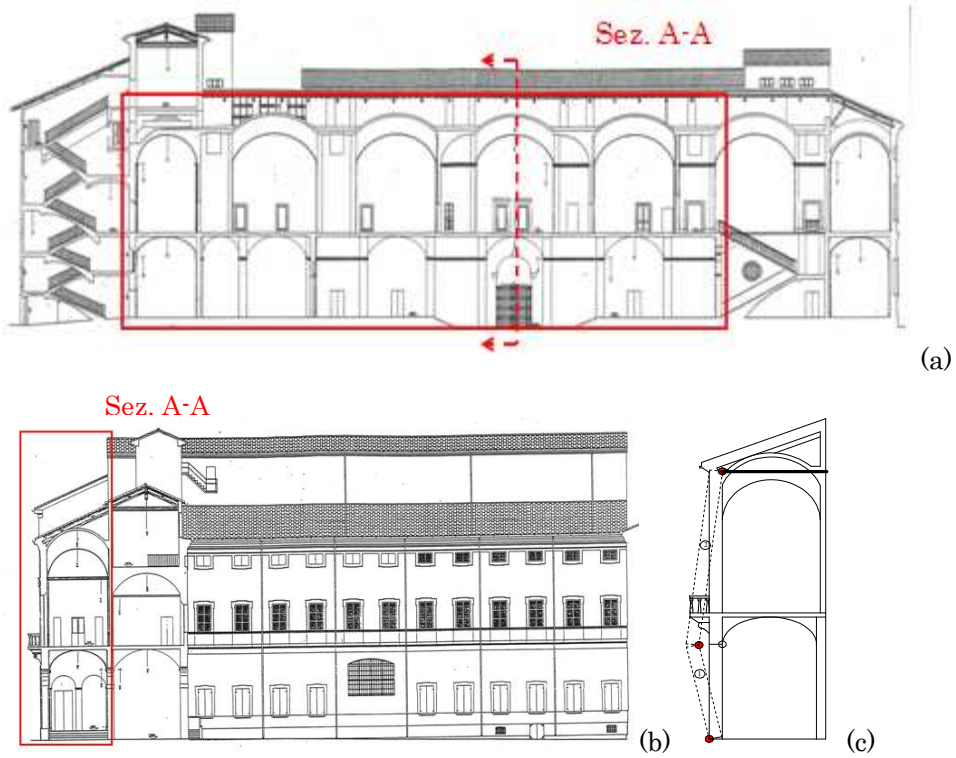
(a) Prospetto lato ingresso, (b) prospetto lato cortile interno.
